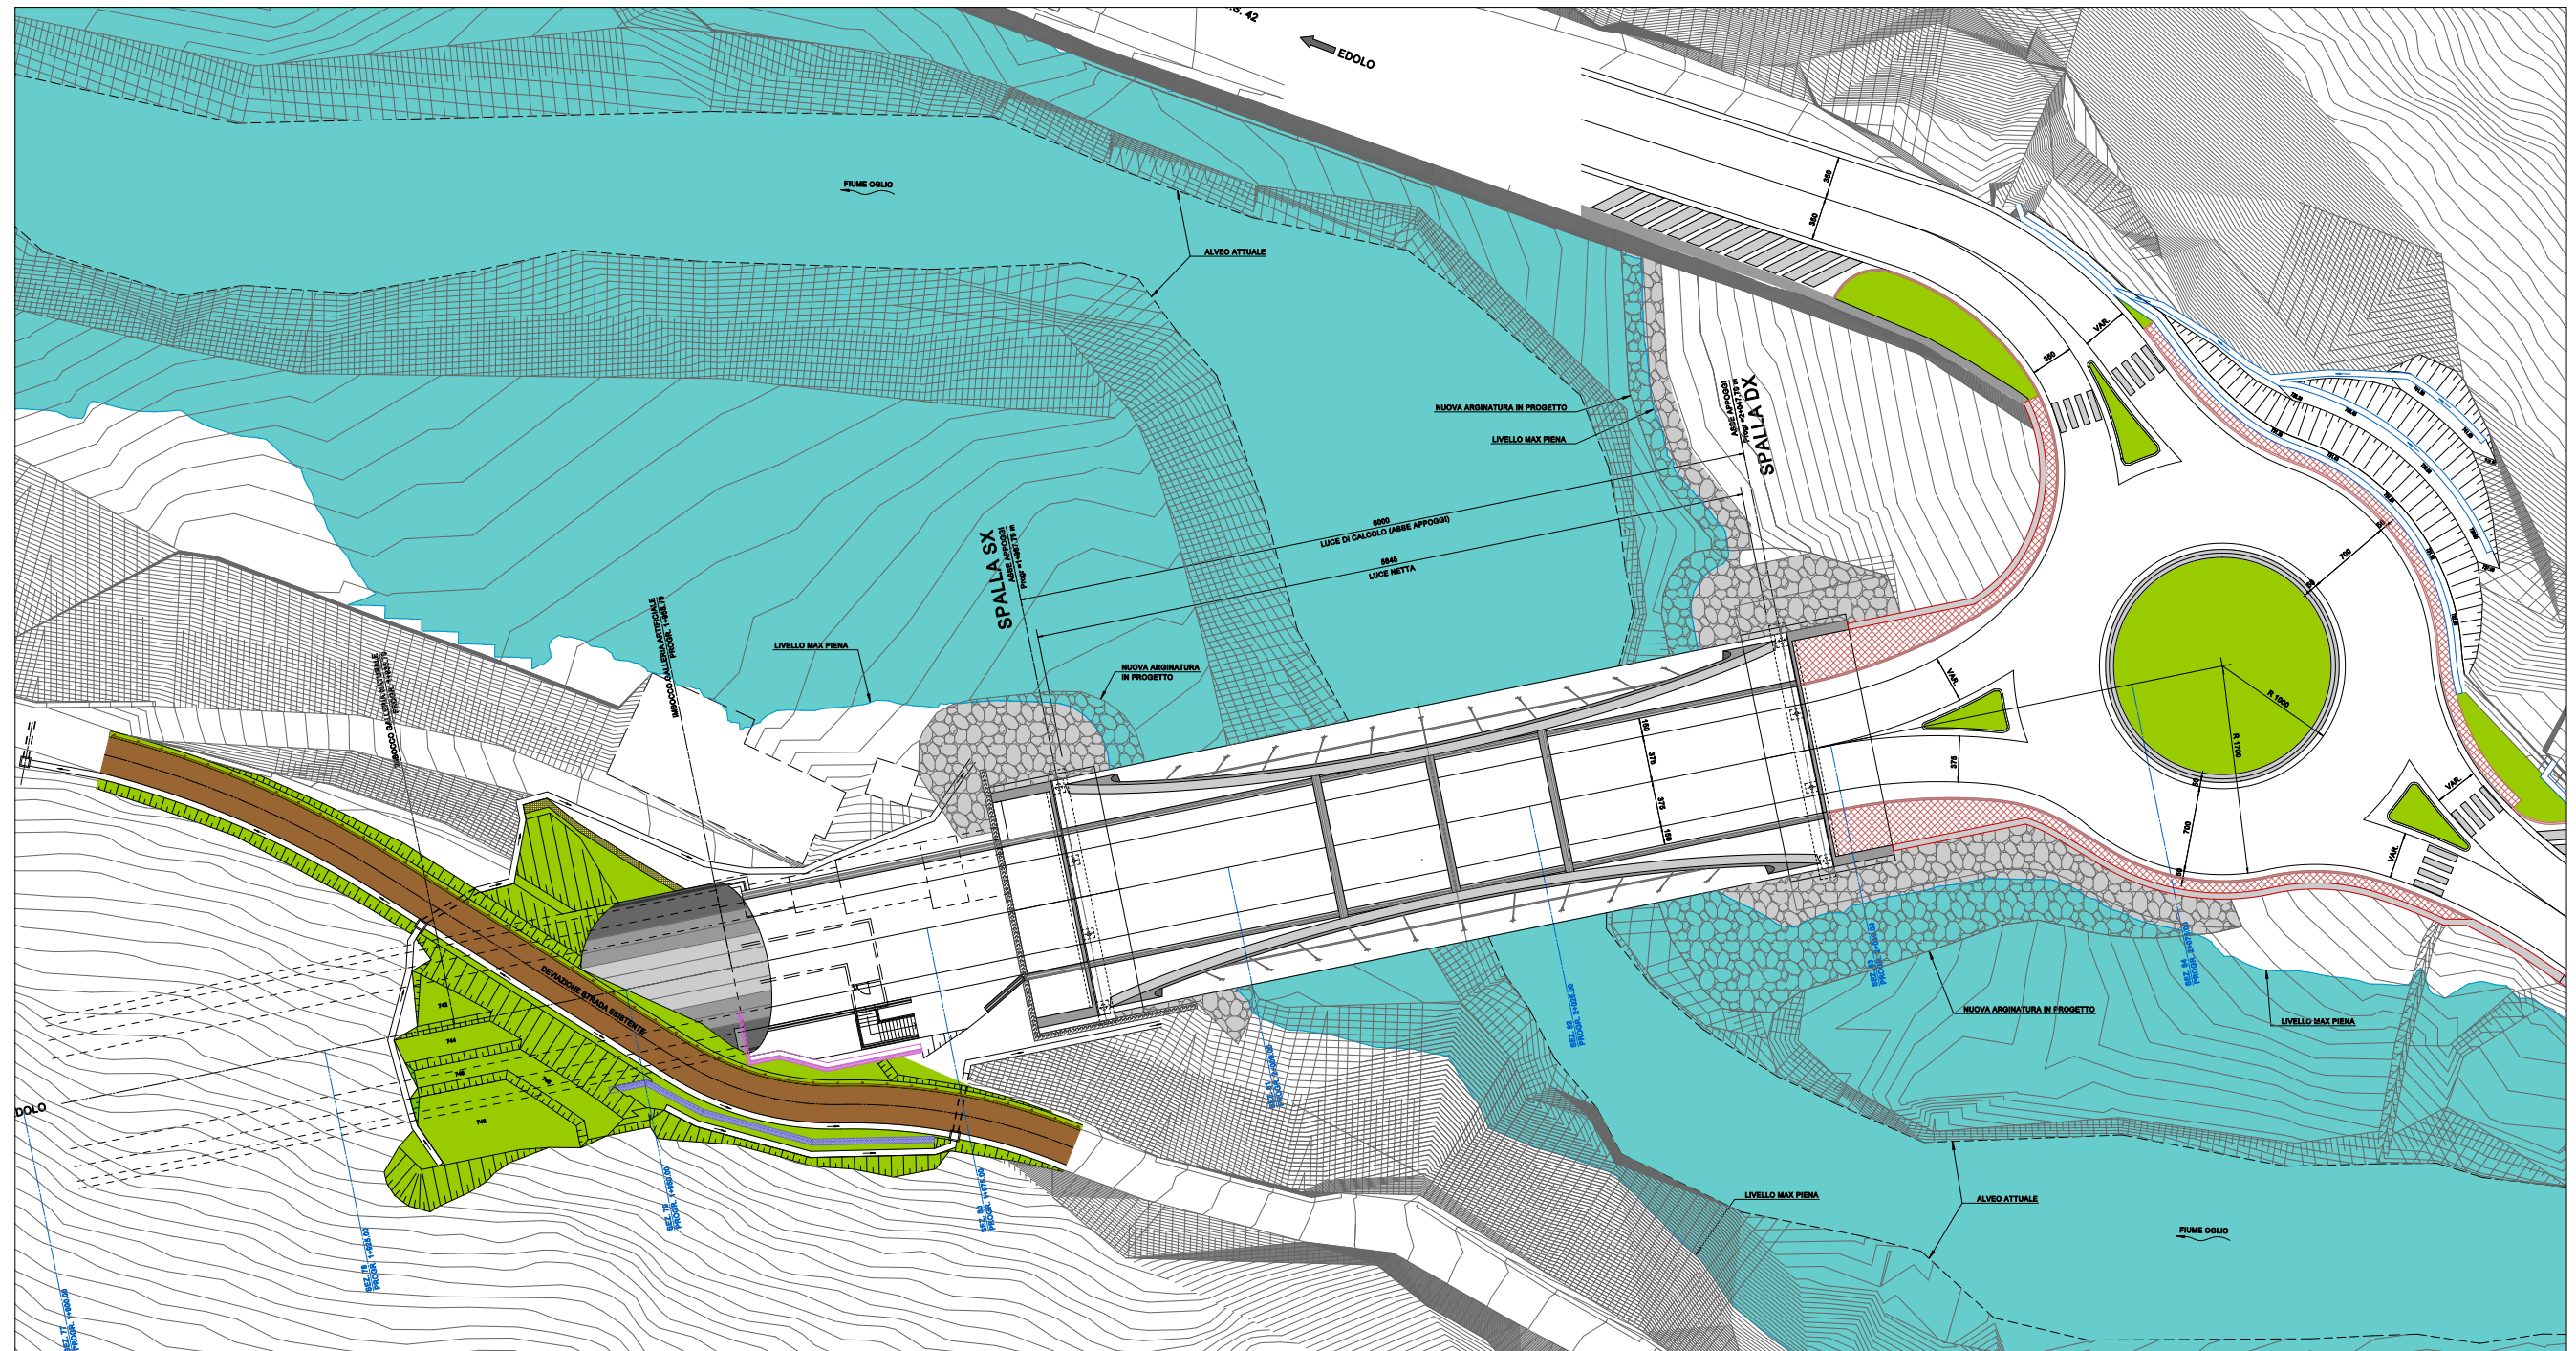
Stralcio planimetrico del tratto finale della Variante
